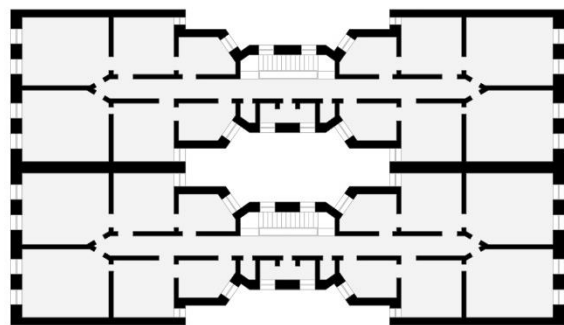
Planta típica de Dumbbell tenement. Fuente: Slideplayer
